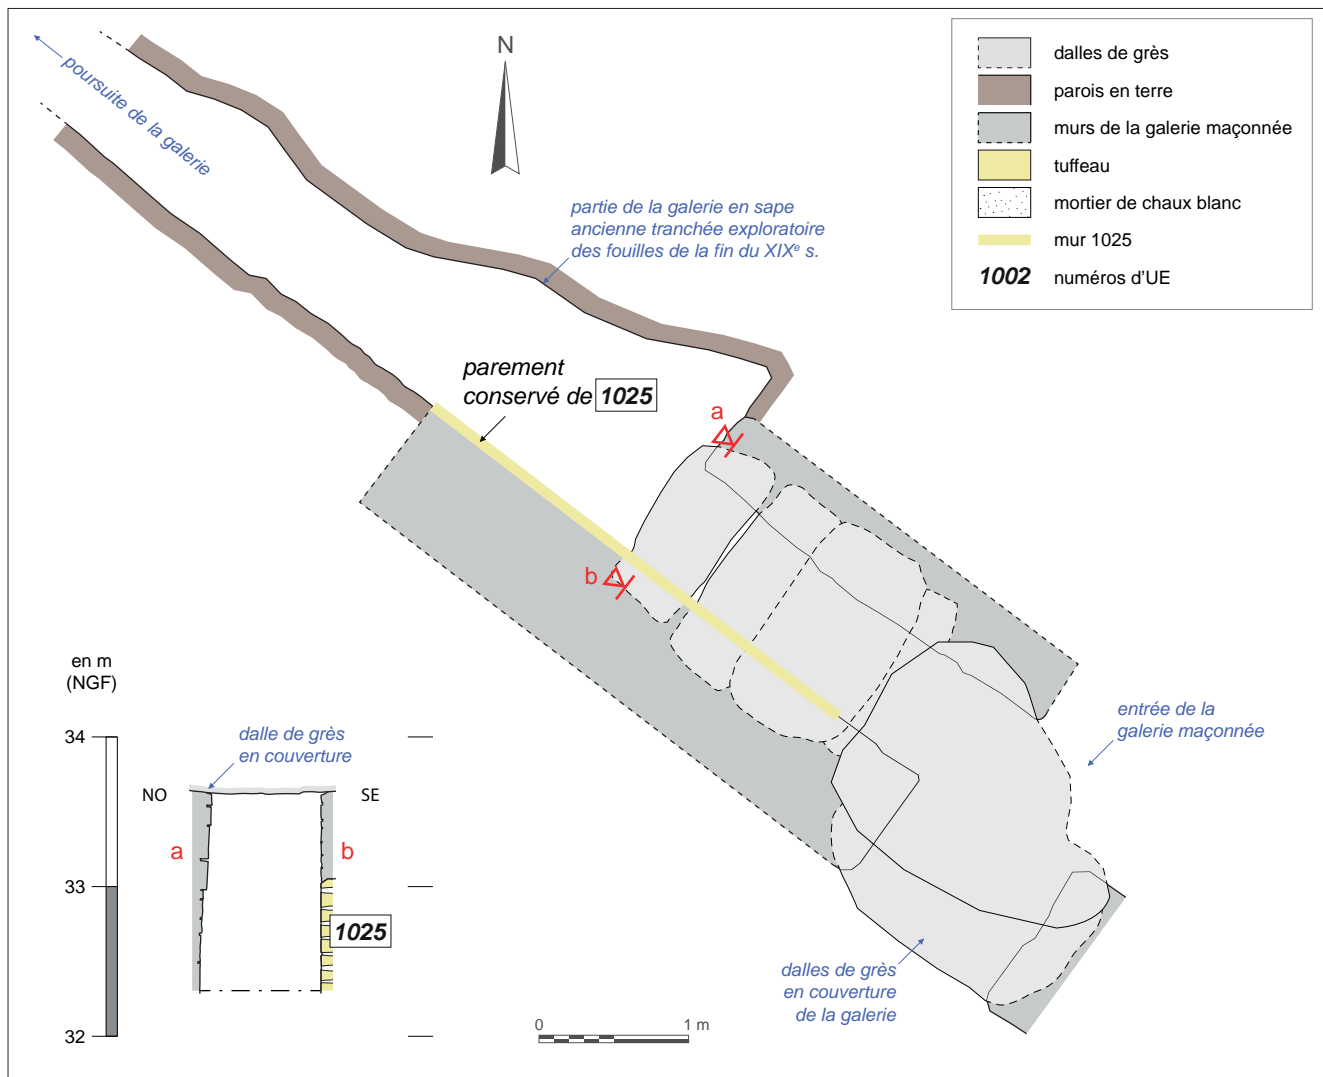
Plan et profil de la galerie souterraine maçonnée © DAO X. Favreau, 2022.
